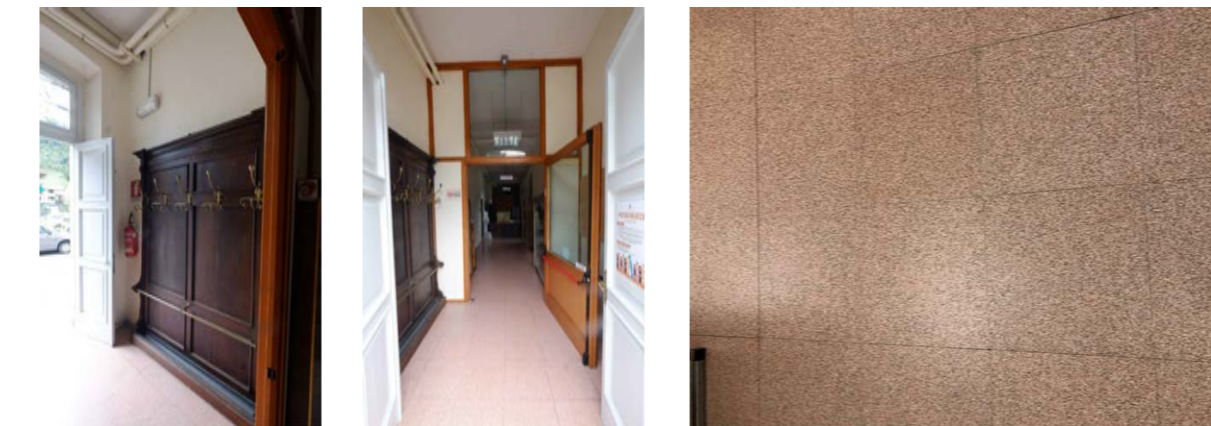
FOTO 2 TIPOLOGIA PAVIMENTAZIONE
